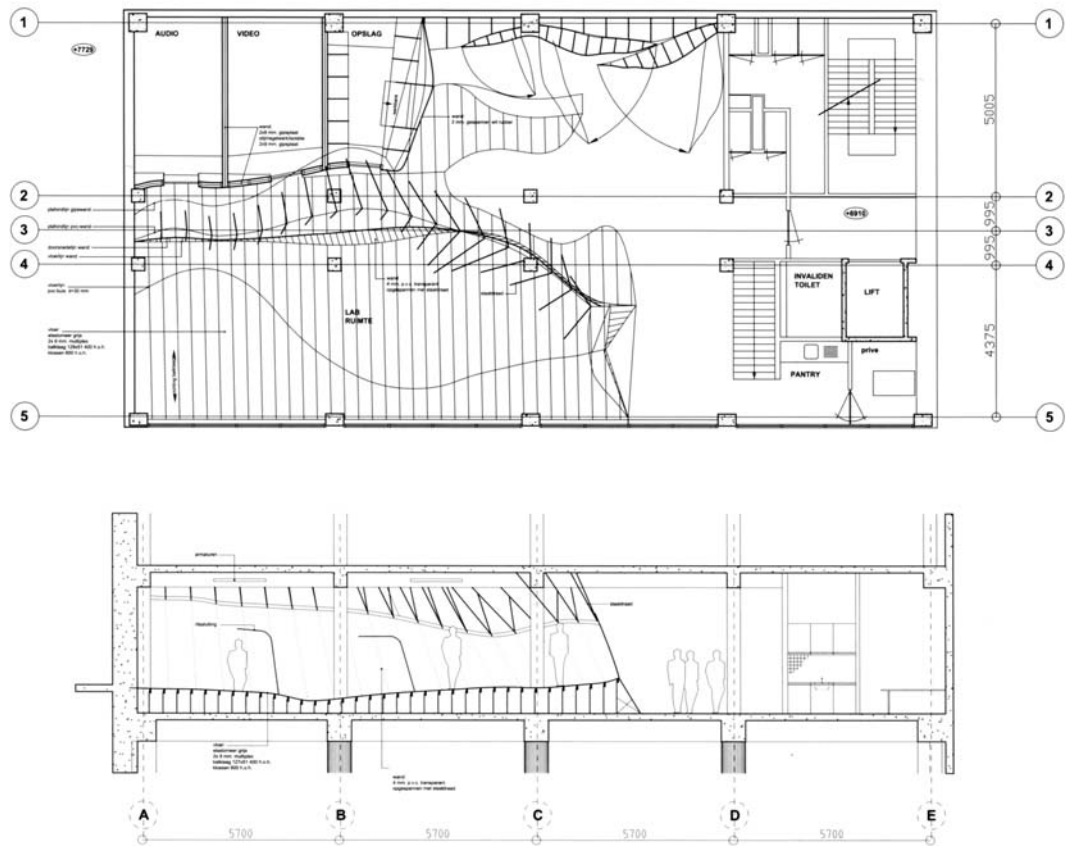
Planta y sección del proyecto V2_Lab (1998).
